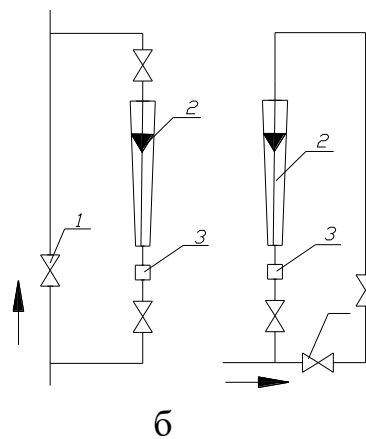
Схемы установки ротаметров в системах промышленных трубопроводов: а - стеклянного на вертикальном трубопроводе; б – то же на горизонтальном трубопроводе: 1 - вентиль; 2 - ротаметр; 3 - вставка центрирующая
